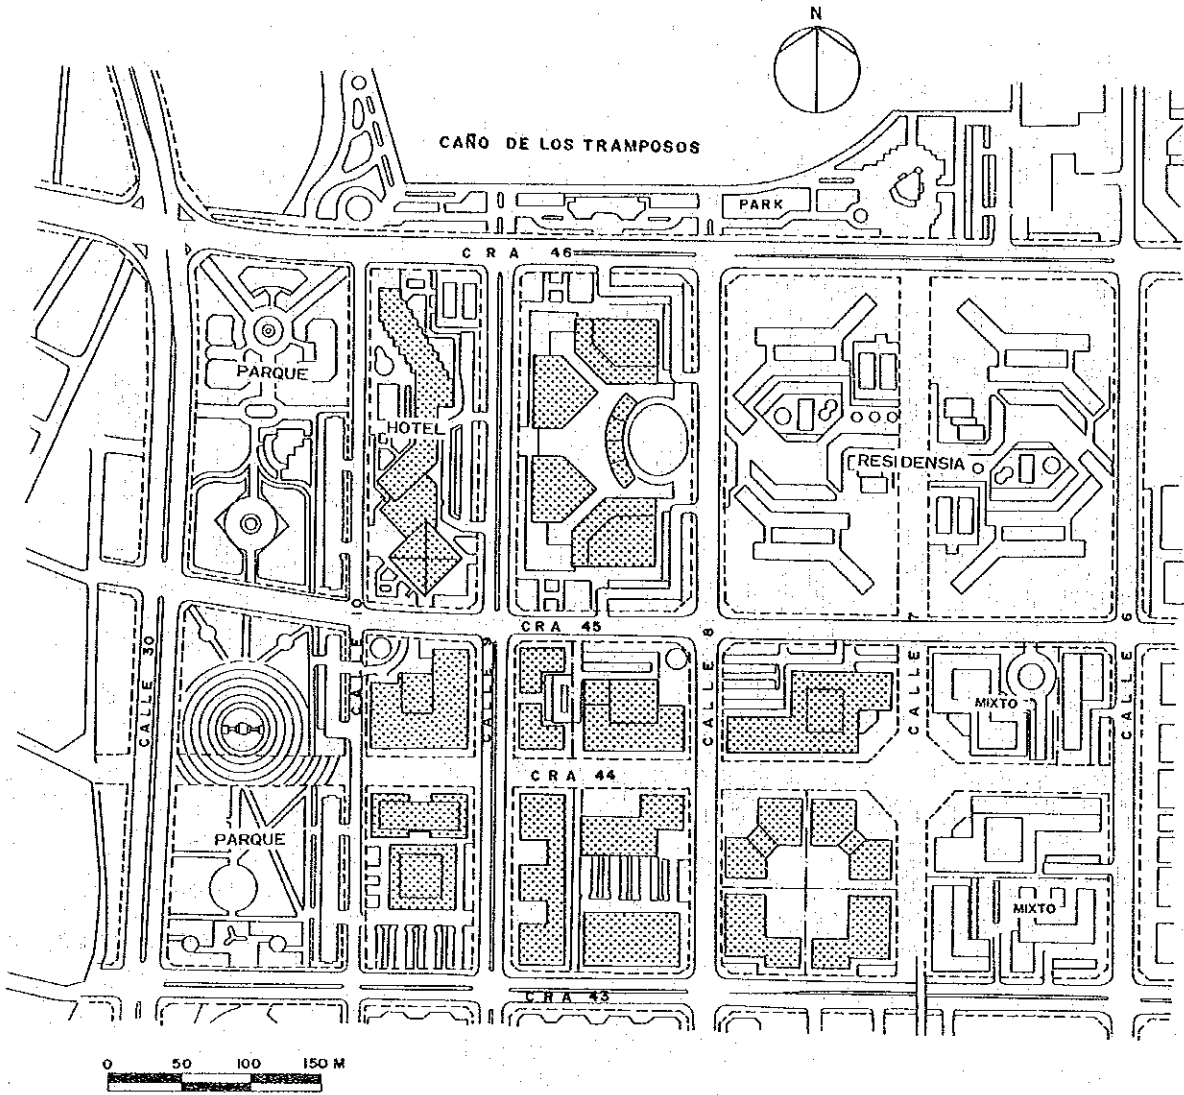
DISPOSICION ESTRUCTURAL PROPUESTA DE LA ZONA DE NEGOCIOS
